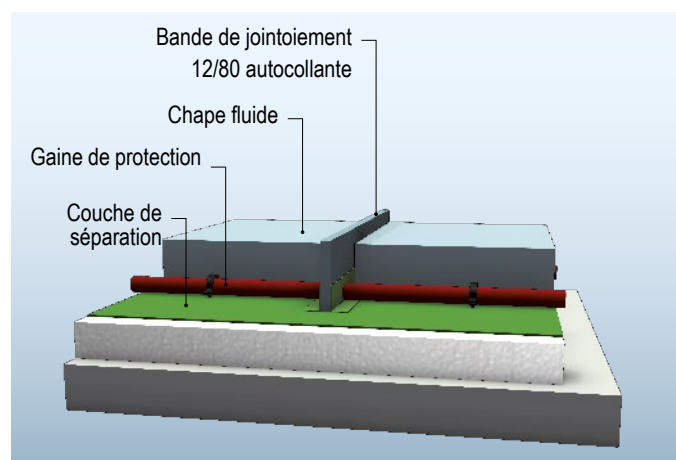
Variante d'exécution 4 : Joints avec profilé en L
